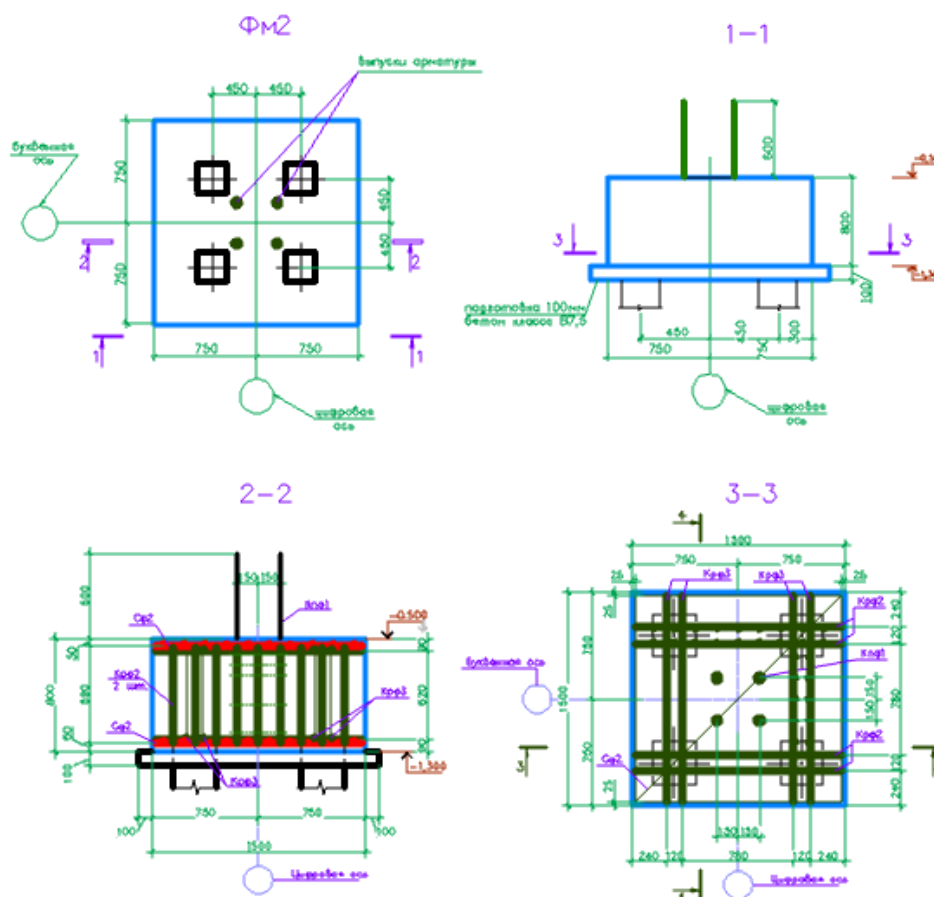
Сечение ростверка и чертеж каркаса.
